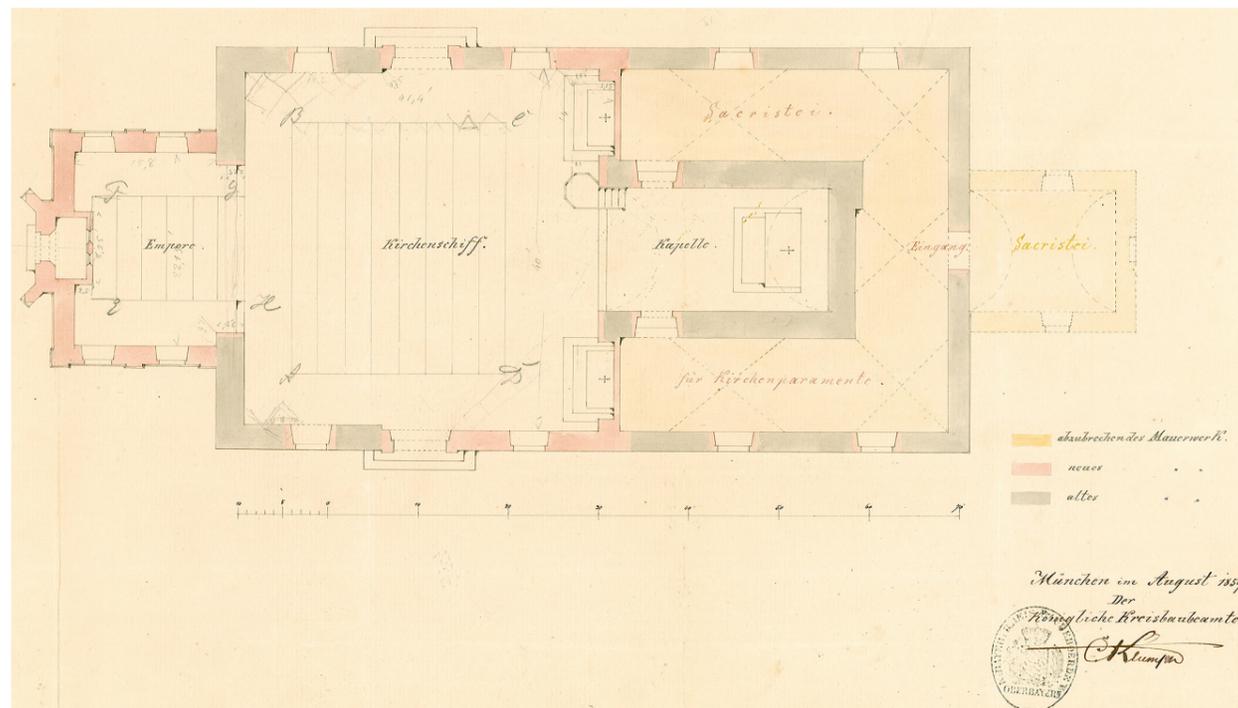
Grundrissplan von 1859 der Pfarrkirche Maria Loreto (Archiv Staatliches Bauamt Rosenheim)
